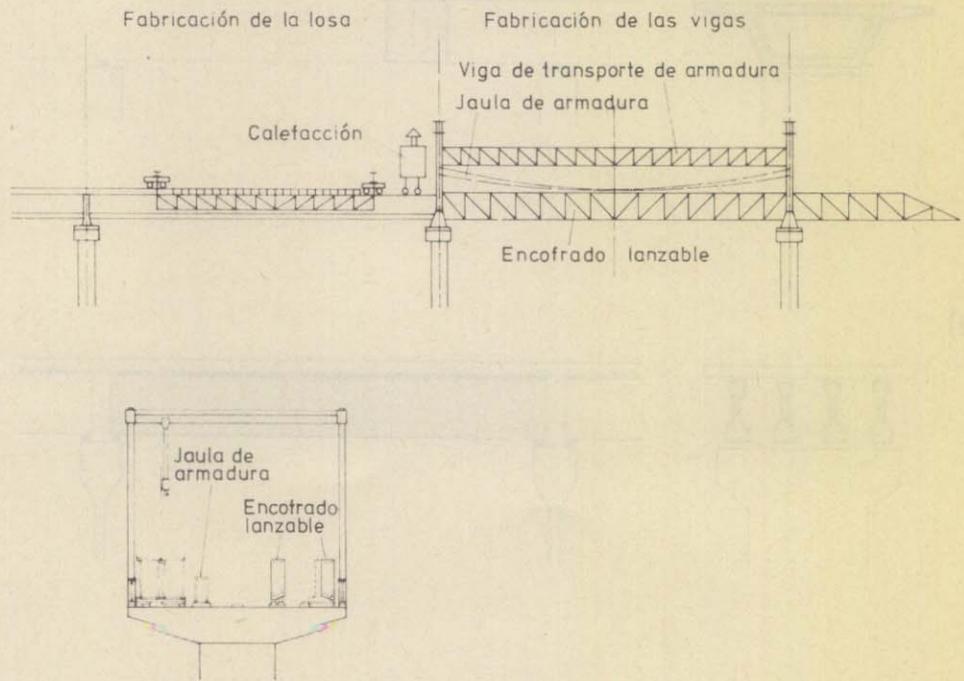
Fabricación de vigas según el sistema Schrack, según (28).
